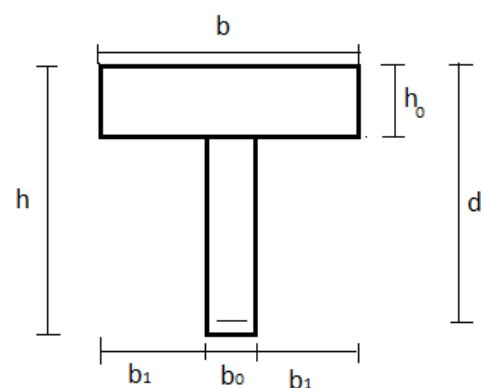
Section de calcul de la poutrelle après coulage de la dalle de compression
